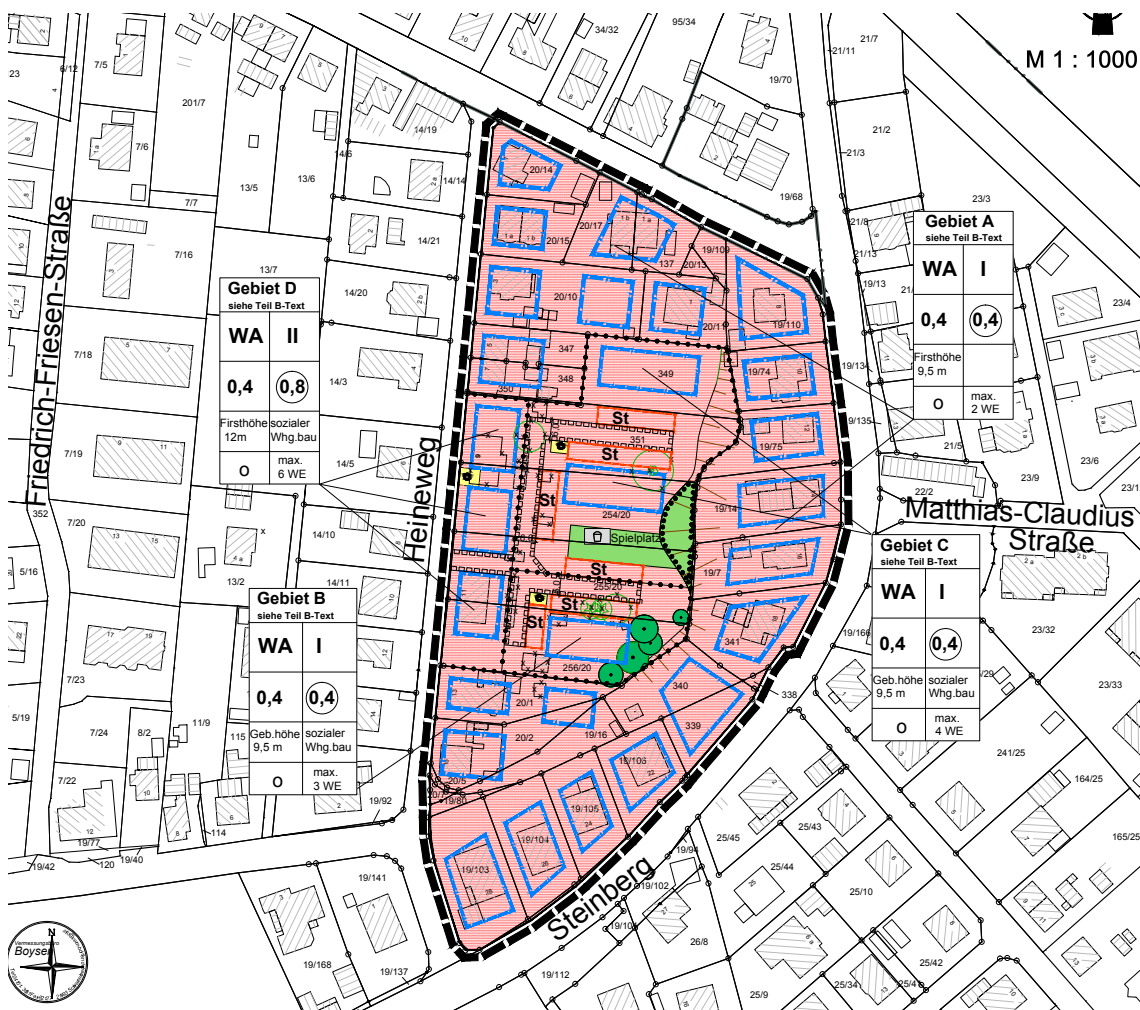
Planzeichnung BP Nr. XII / 12 (Verfahrensstand: Beschlussfassung)
